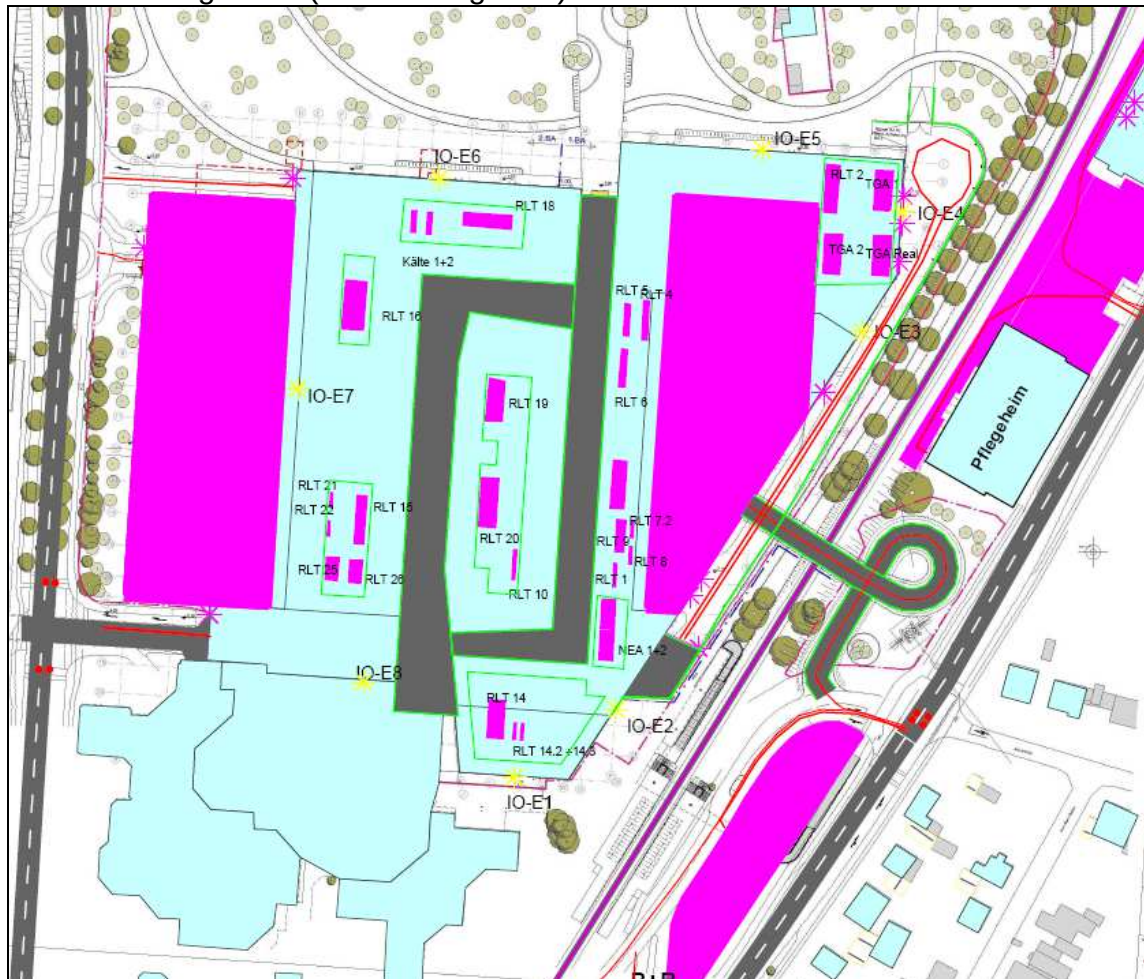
Lageplan – Immissionsorte im eigenen Bereich (Anlage 1.4)
